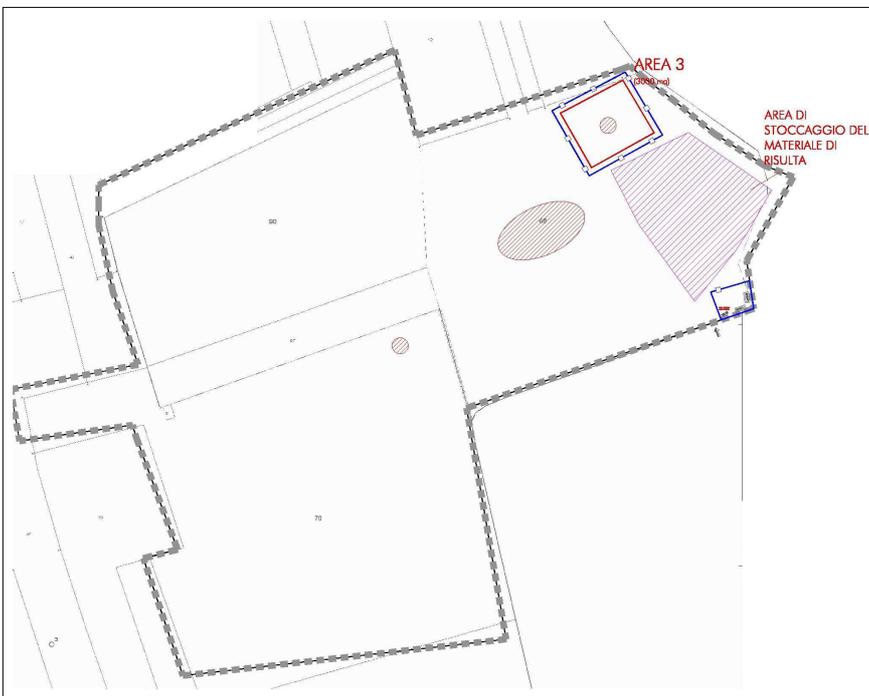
Planimetria della terza fase di scavo – Area 3
